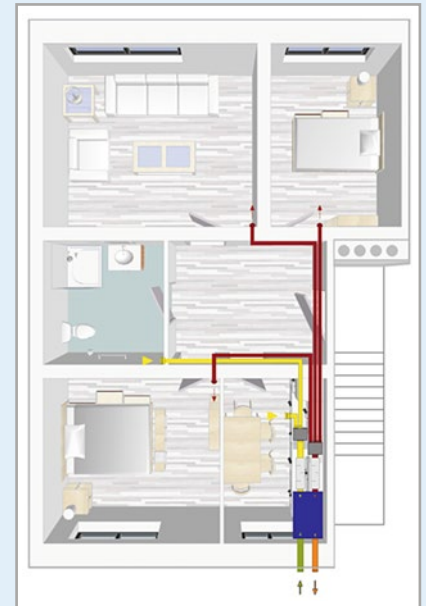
Darstellung des Lüftungskonzepts im Grundriss
